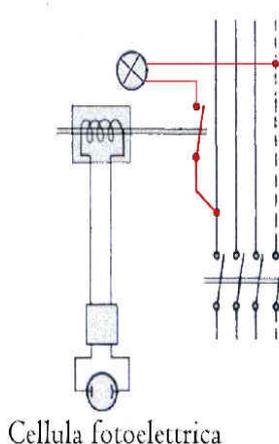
Impianto con apparecchio di illuminazione derivato direttamente dalla rete di b.t.
